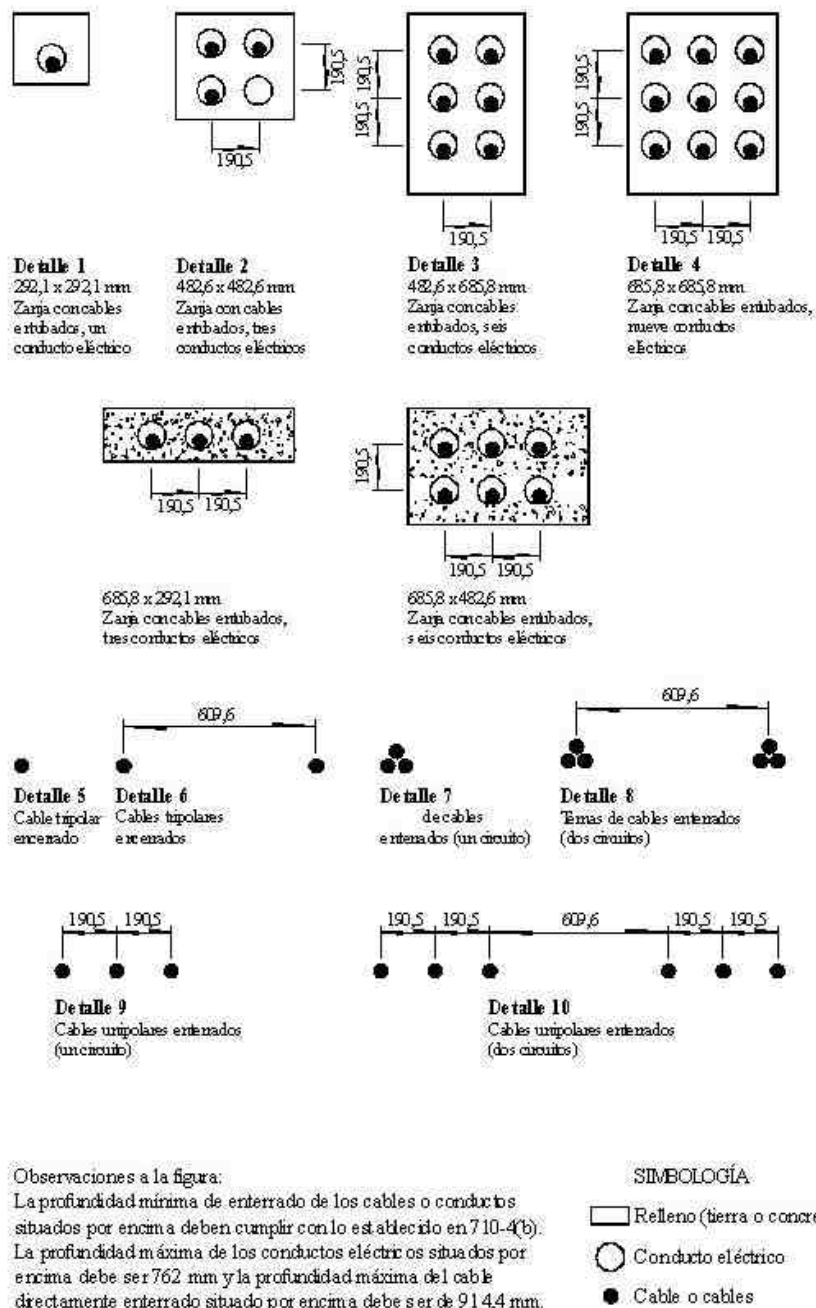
Dimensiones para la instalación de cables en ductos aplicables a las Tablas 310-77 a 310-86
